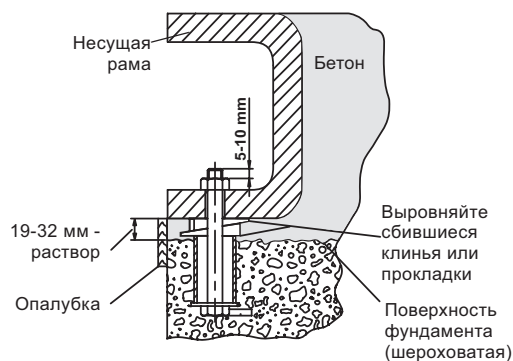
Вид в разрезе фундамента с фундаментным болтом, бетонной заливкой и плитой-основанием
